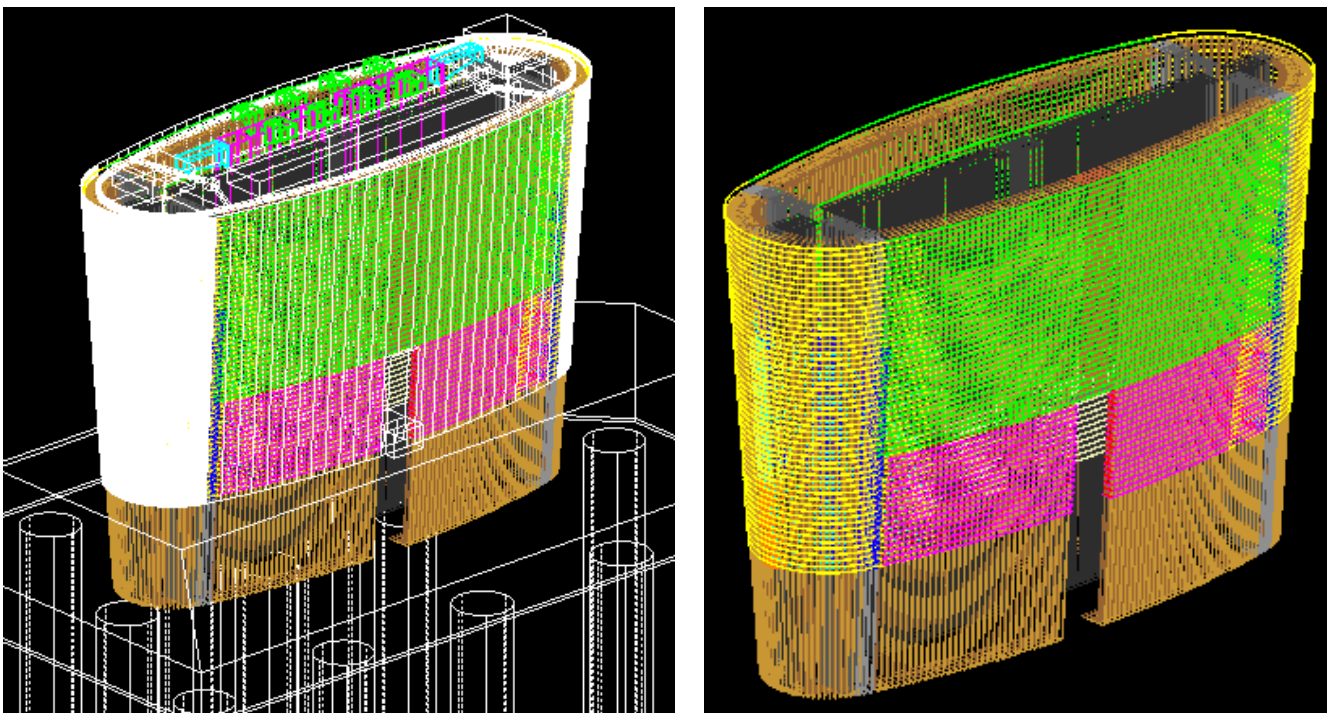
Representação tridimensional das armaduras longitudinais e transversais do pilar PC1
